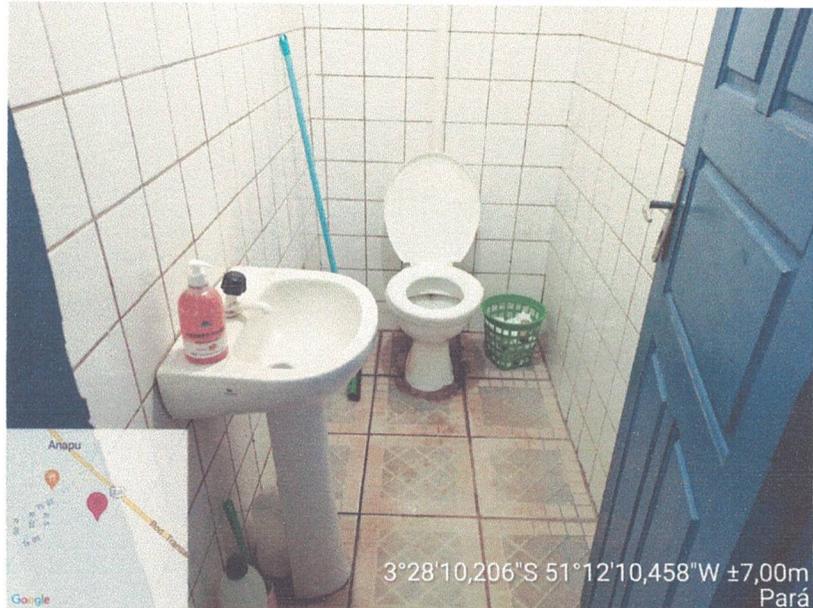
VISTA INTERNA DA COORDENAÇÃO
